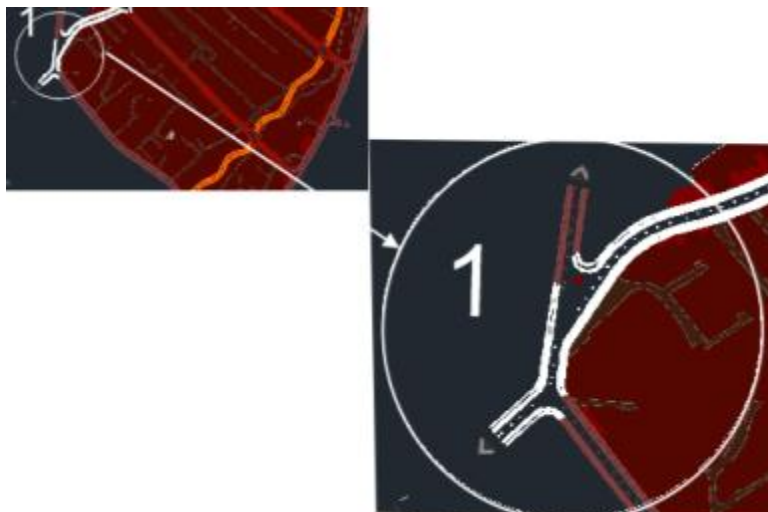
Udhëkryqi Rruga e Llapit – Rruga Bajram Bahtiri
